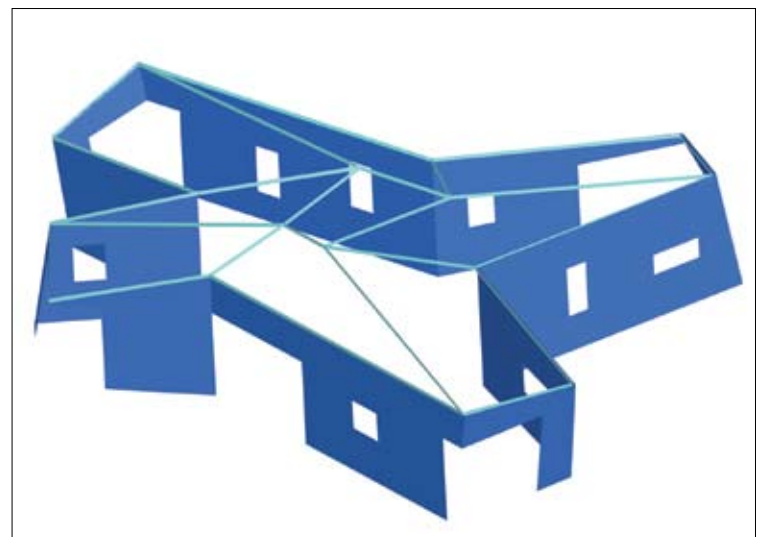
Konstrukcija aluminijastega skeleta paviljona (konstruiranje: RPS)
